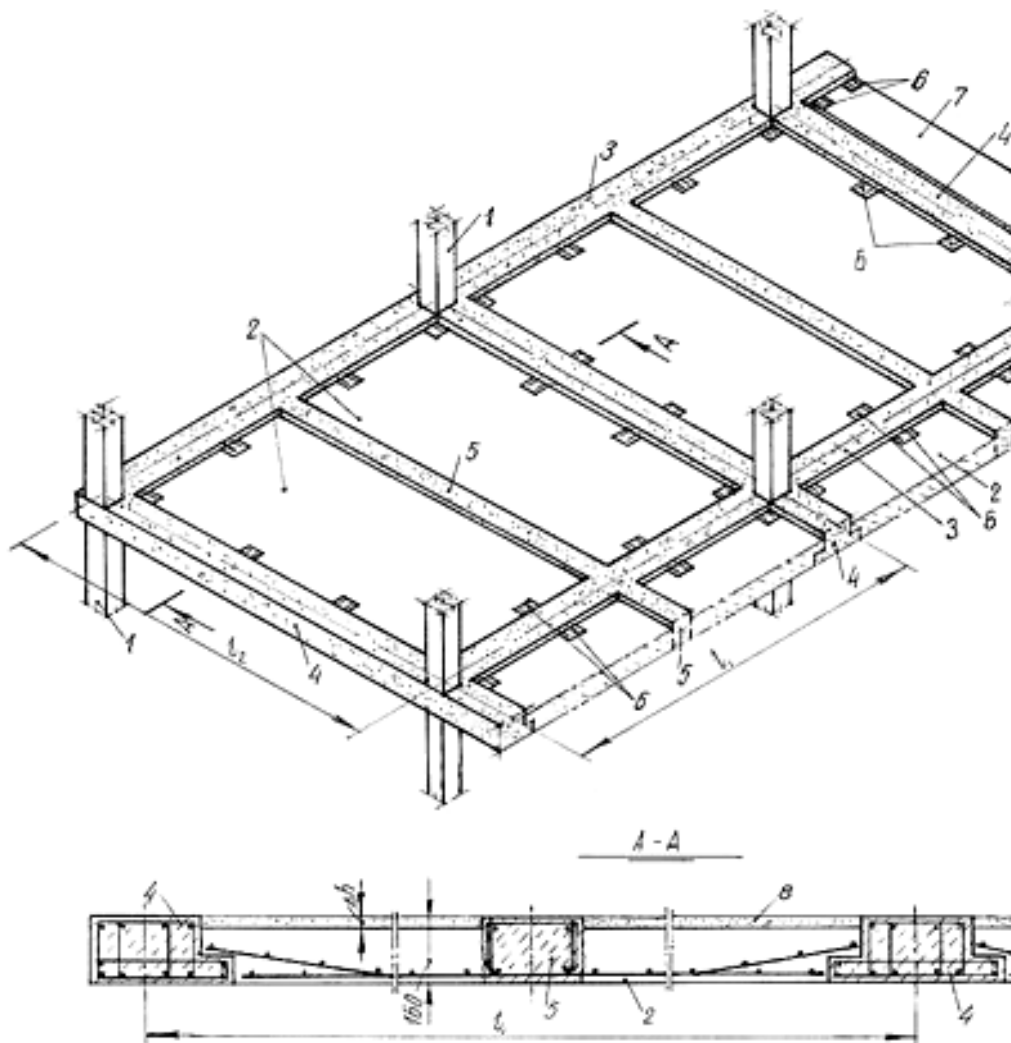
Конструкция сборно-монолитного каркаса, выполняемого с применением плоских железобетонных плит кассетного производства ДСК: 1 – колонны; 2 – сборные плоские плиты; 3, 4 – монолитные ригели; 5 – монолитные стыки сборных плит; 6 – закладные детали; 7 – плита балконной консоли; 8 – монолитная стяжка пола
